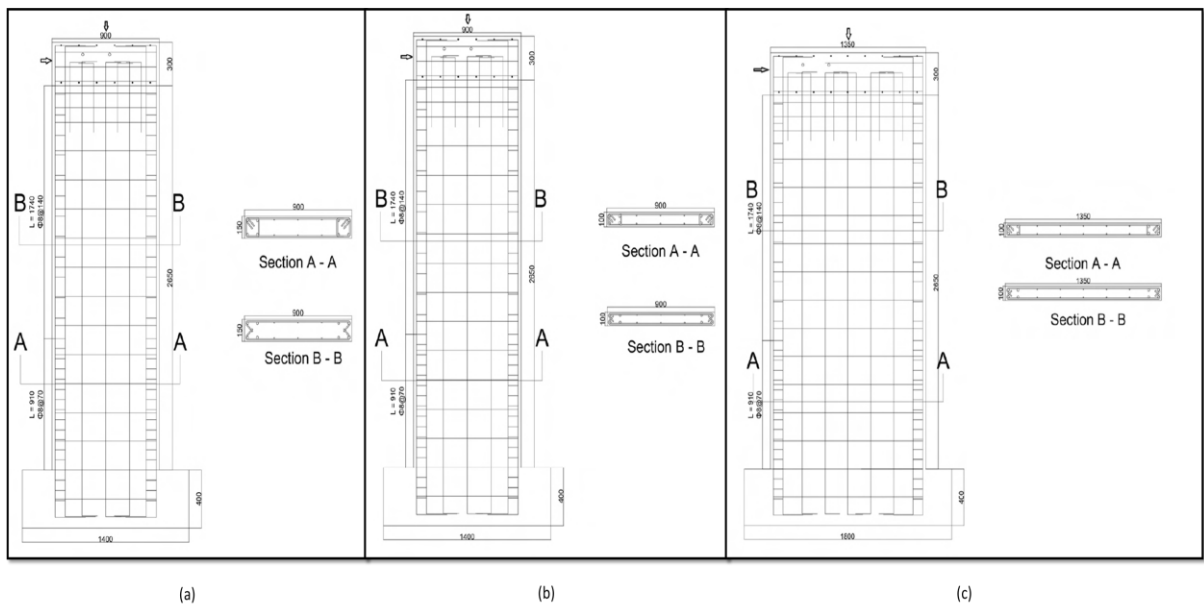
Esquemas de las probetas. Muro M1 (a); Muro M2 (b); Muro M3(c) (adaptada de Jara [22]).
